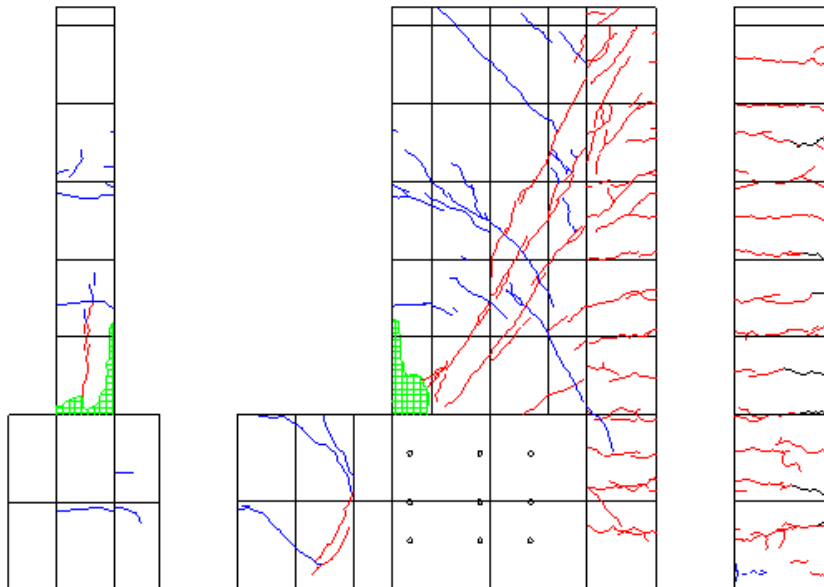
R=1/50 ひび割れ図
